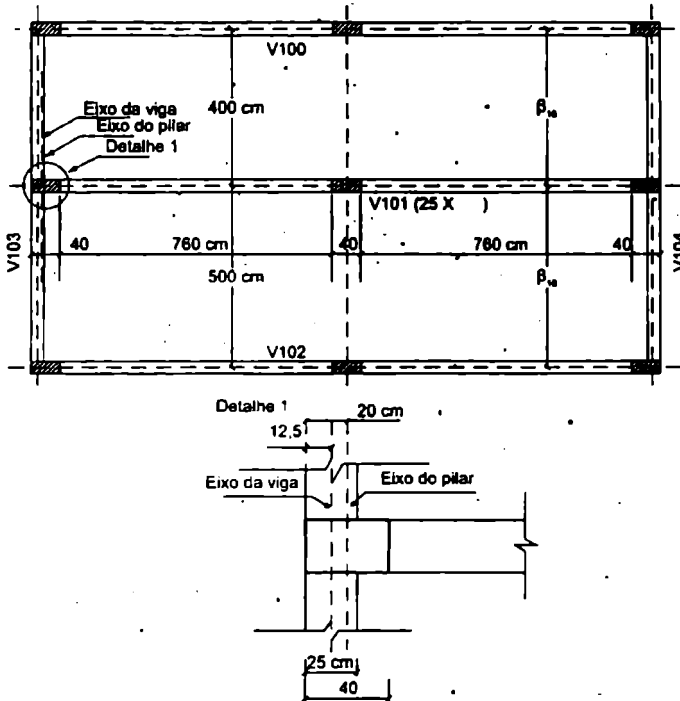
Planta da fôrma da estrutura cuja viga V101 será calculada.
